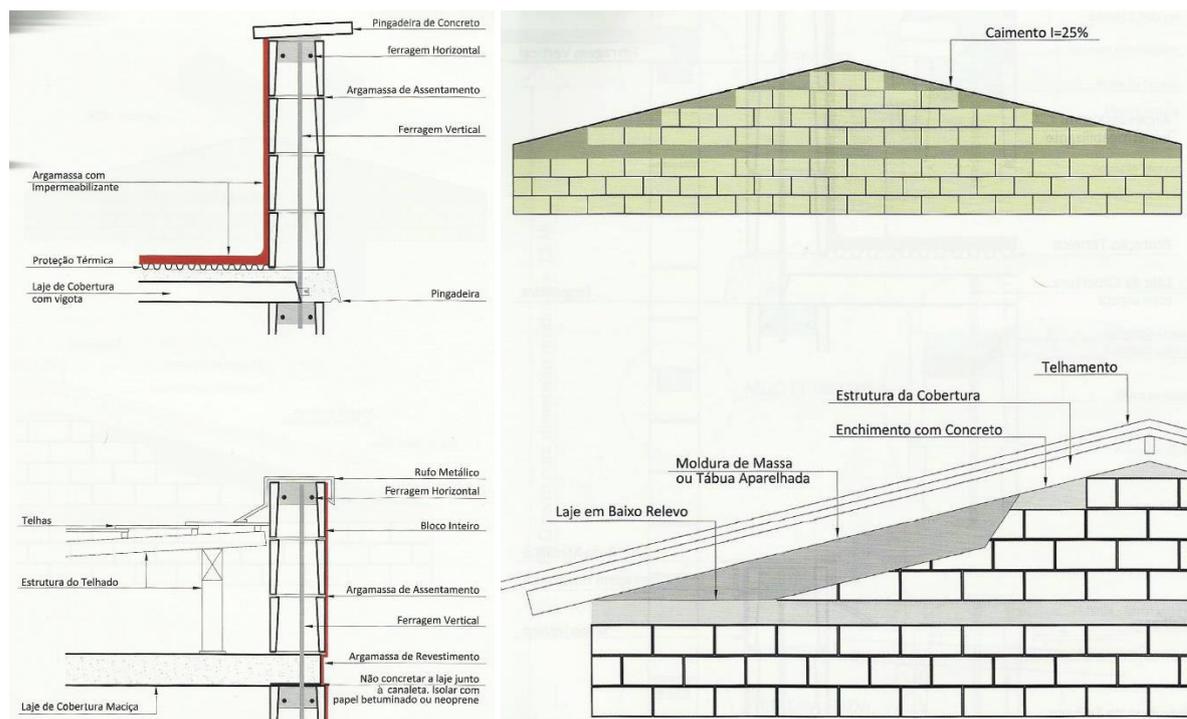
Explicação do processo de construção de coberturas com platibanda e telhado aparente, respectivamente. Fonte: NESE e TAUIL, 2010, montagem da autora.
